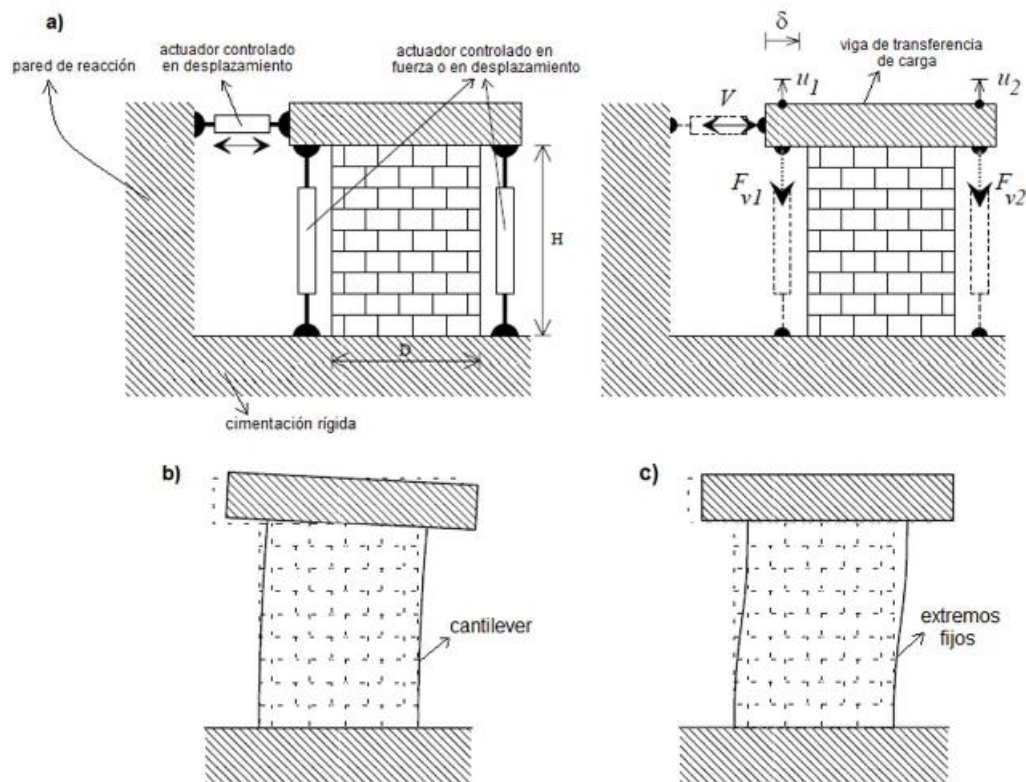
Condiciones de borde en pilares: a) componentes de ensayo estándar; b) pilar en cantiléver; c) pilar con extremos totalmente fijos. Fuente: Adaptado de Mágenes et al. (2000) por Jiménez (2016).
